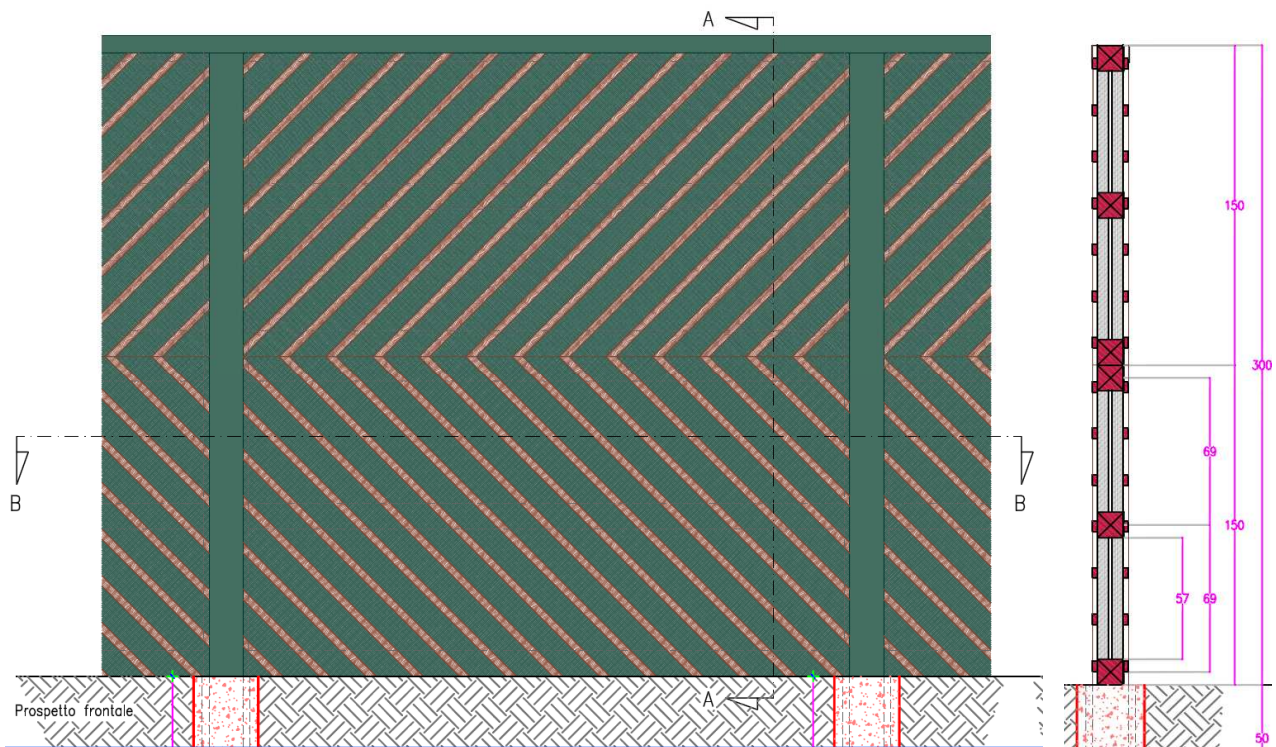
BARRIERA ACUSTICA IN LEGNO: VISTA PROSPETTICA E SEZIONE VERTICALE
